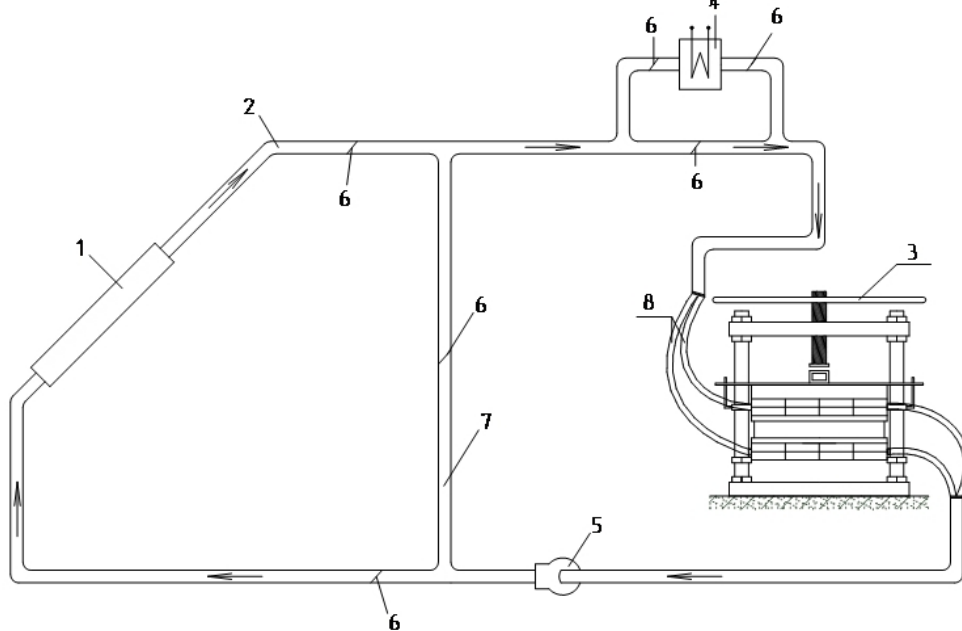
Схема геліоустановки для термообробки бетонних і залізобетонних виробів:
